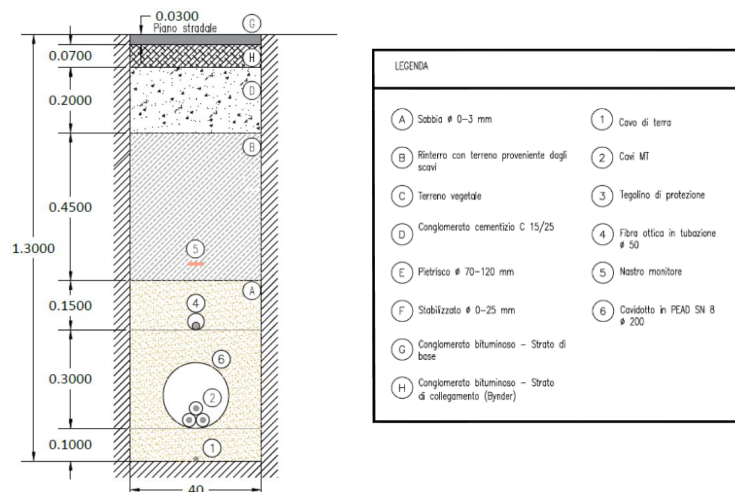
Sezione tipo del cavidotto su viabilità di progetto
